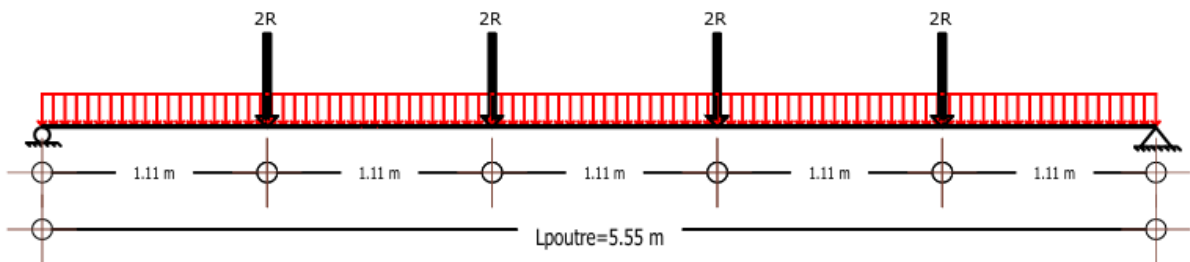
« Schéma statique de la poutre la plus sollicité »
